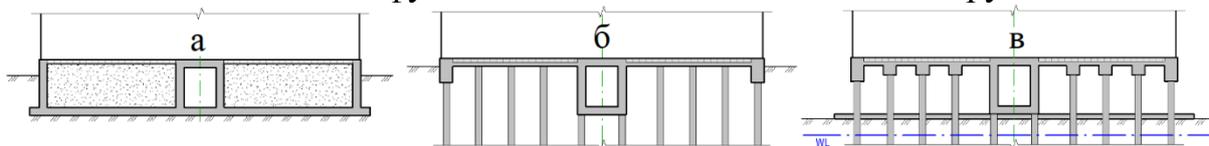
Типи фундаментів металевих силосів для зерна на ділянках із особливими властивостями: а) плитний фундамент коробчастого типу ; б) пальовий із плитним ростверком; в) пальовий із плитним ростверком та надземною галереєю
